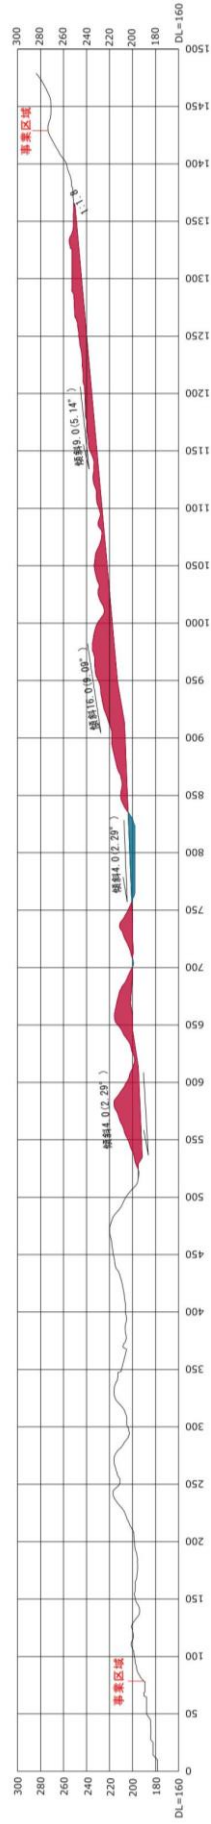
(5) 切土・盛土計画断面図 (E5-E5' 断面)
